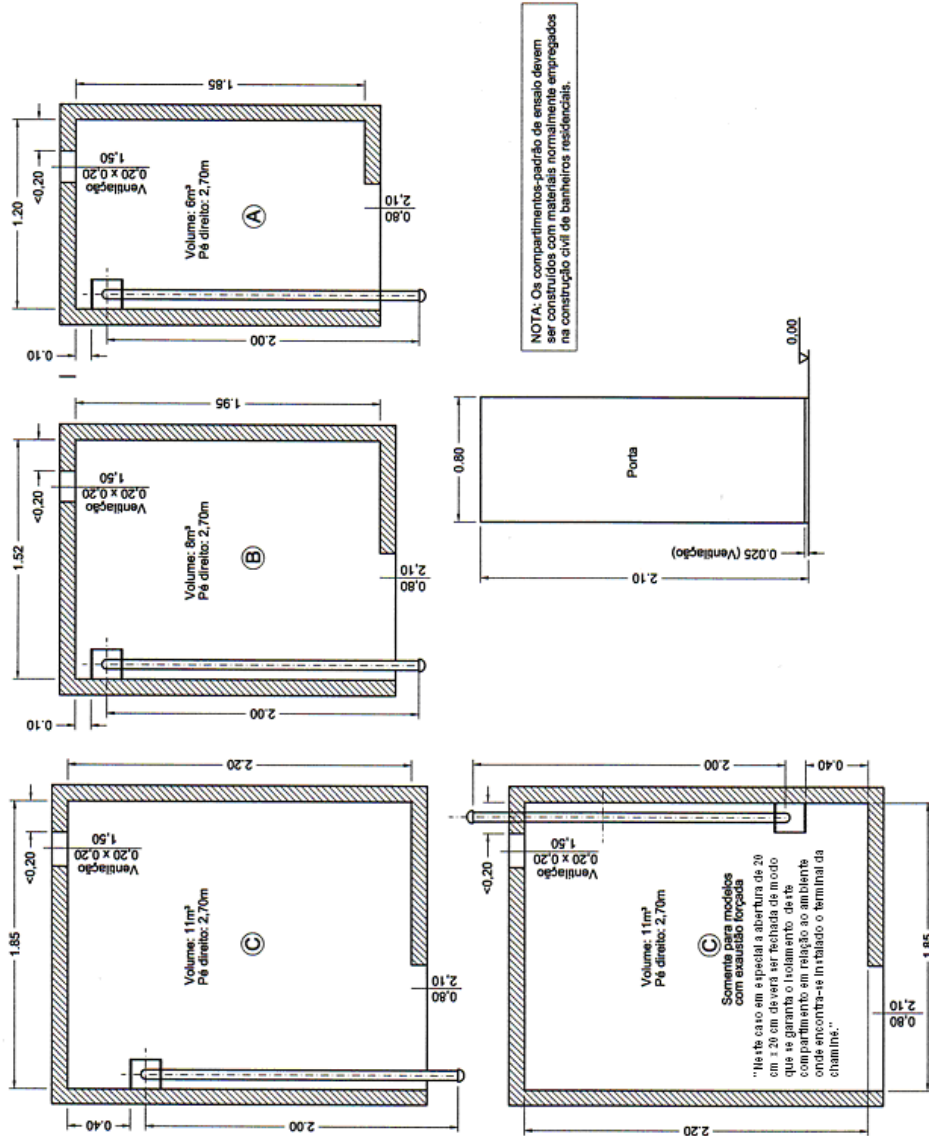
Abertura para ventilação e dimensões das salas de ensaio
